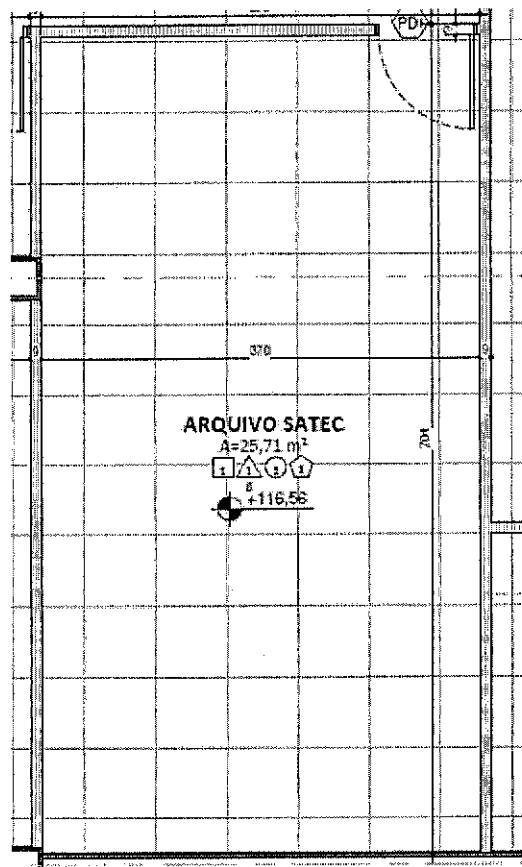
planta do 3º pavimento da obra DRF Bauru (CAT 2620180009585), área de arquivo SATEC com 25,71m². Obra de Construção.
